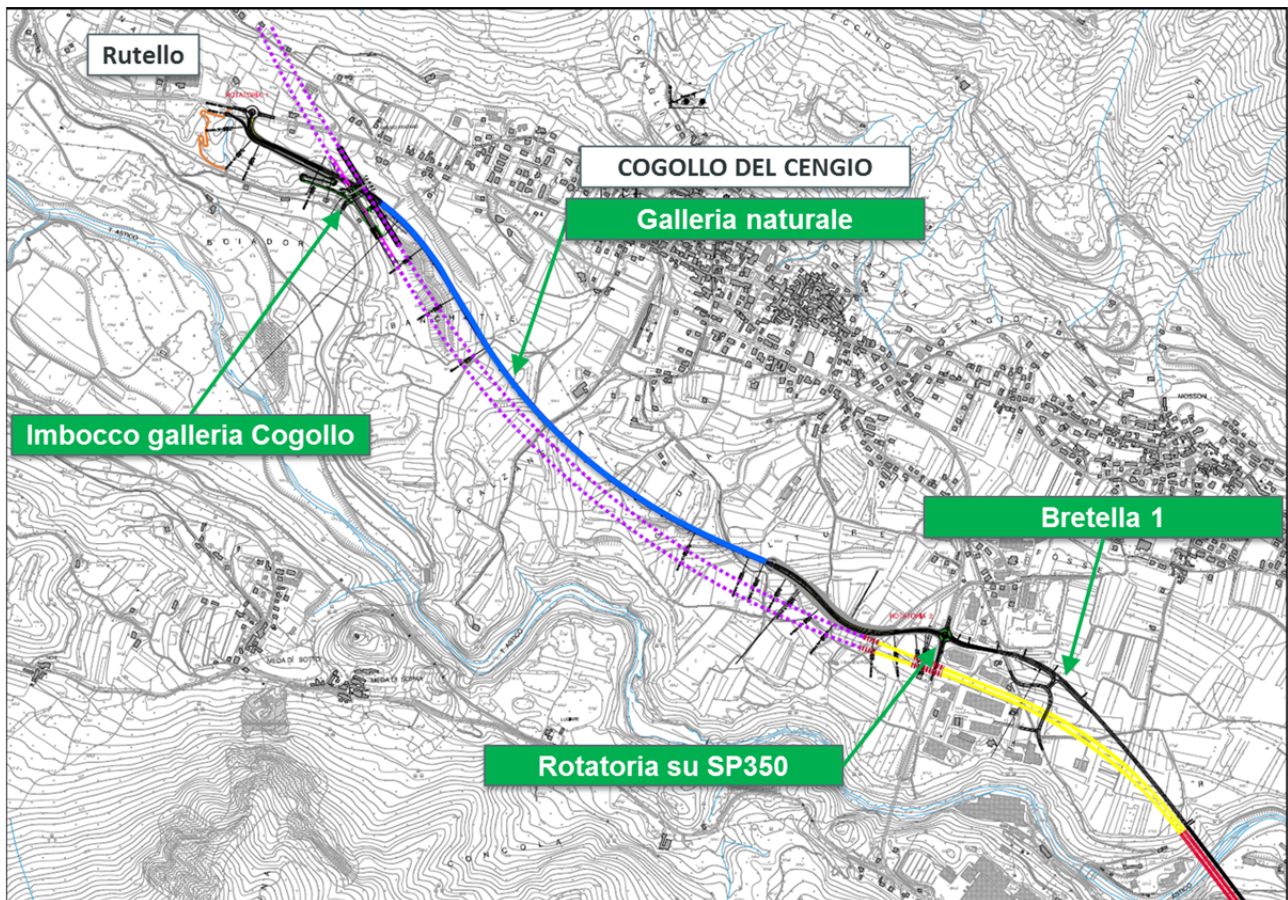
Planimetria della bretella scelta tra Cogollo del Cengio e Rutello
